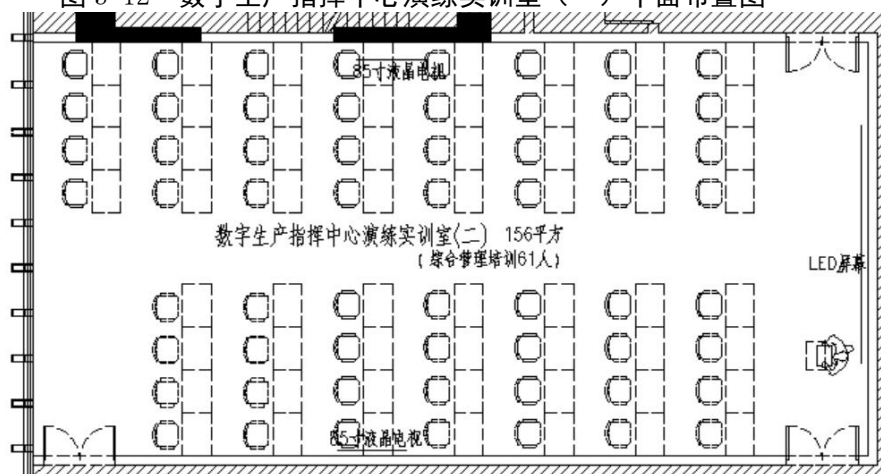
数字生产指挥中心演练实训室（二）平面布置图
